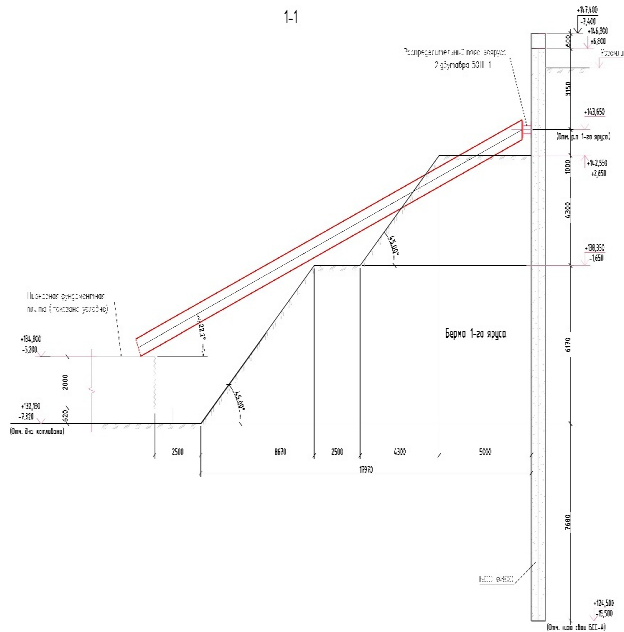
Характерный разрез ограждения котлована (на этапе разработки грунта под защитой грунтовой призмы)
